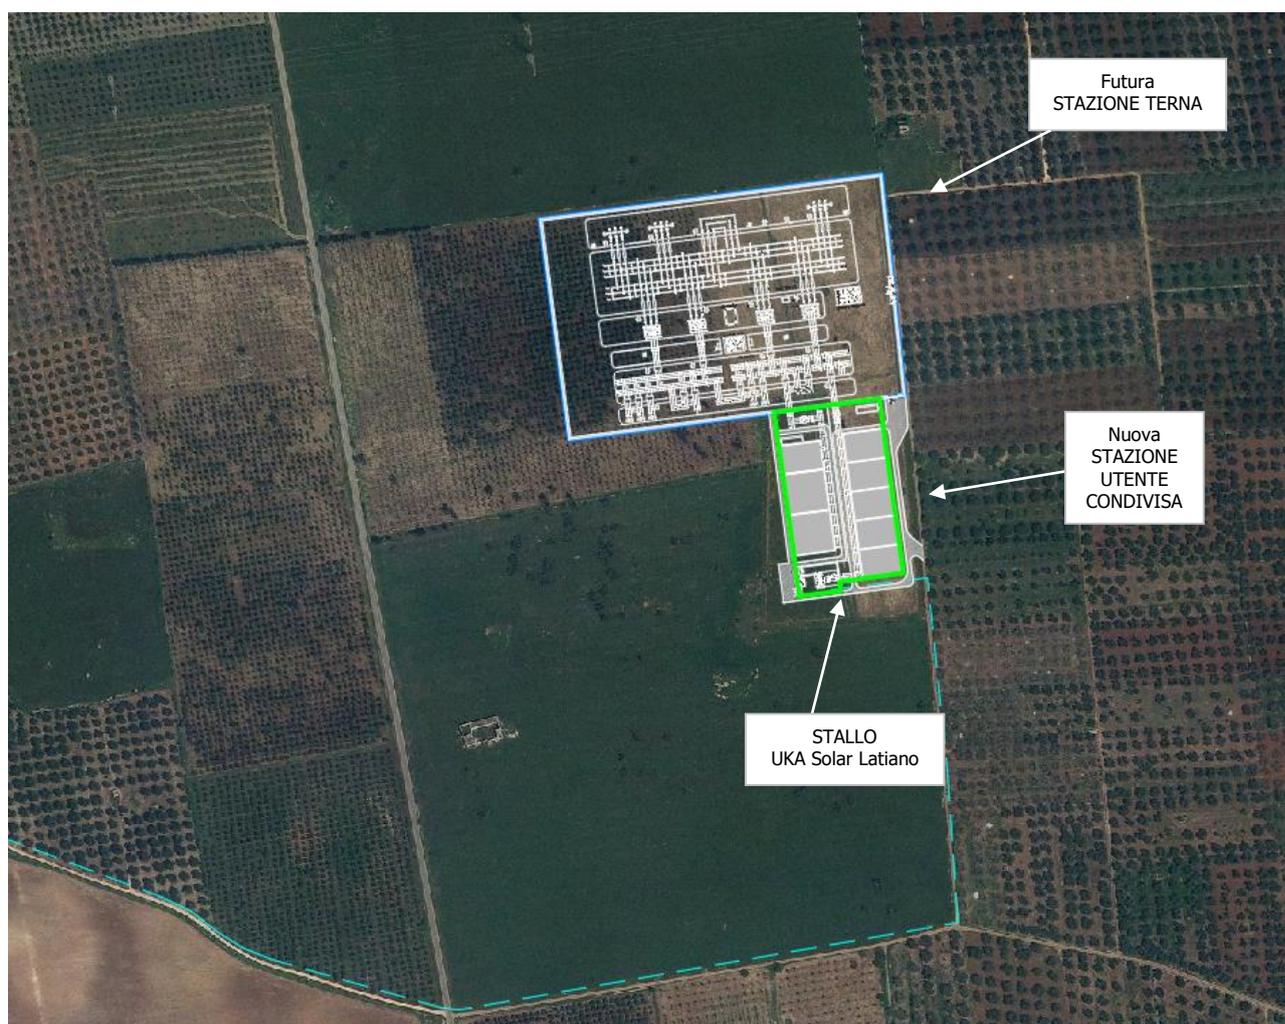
Dettaglio delle opere di connessione su ortofoto
